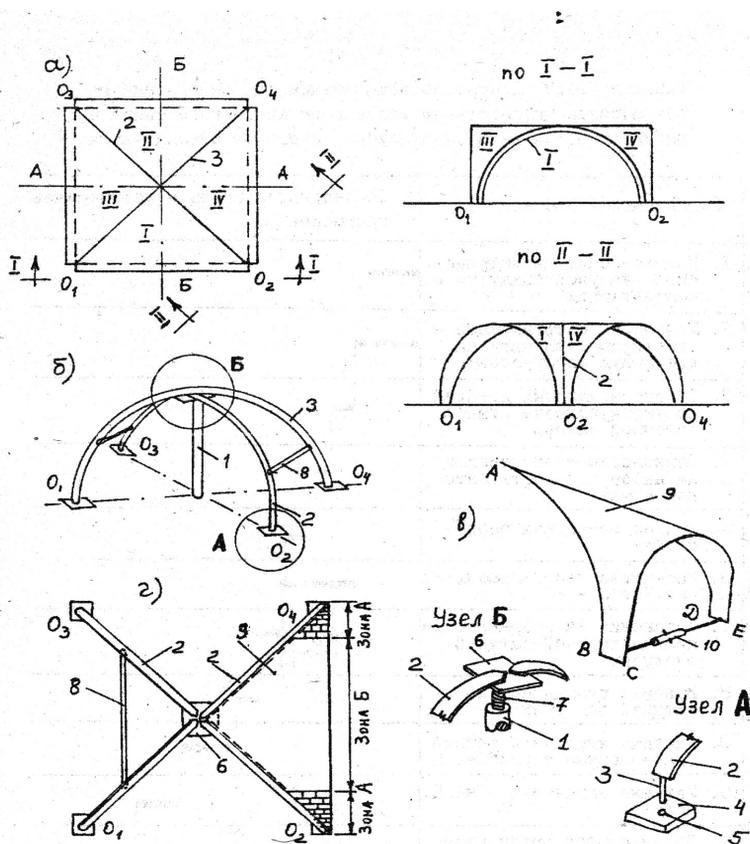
Технология возведения крестового свода при использовании секторно-кружальной опалубки: а) – конструкция крестового свода; б) – сборка оборудования для кладки секторов свода; в) – секторно – кружальная опалубка; г) технология кладки свода в пределах сектора; O_1, O_2, O_3, O_4 – опоры арок-пересечений цилиндрических сводов (А – А) и (Б – Б); I, II, III, IV – секторы крестового свода; 1 – временная стойка; 2 – арка – пересечение (O_2-O_3); 3 – арка – пересечение (O_1-O_4); 4 – фундамент; 5 – отверстие в фундаменте; 6 – опорная плита; 7 – винтовой стержень; 8 – распорка; 9 – секторно-кружальная, переставная опалубка; 10 – тяга с тальрепом.
